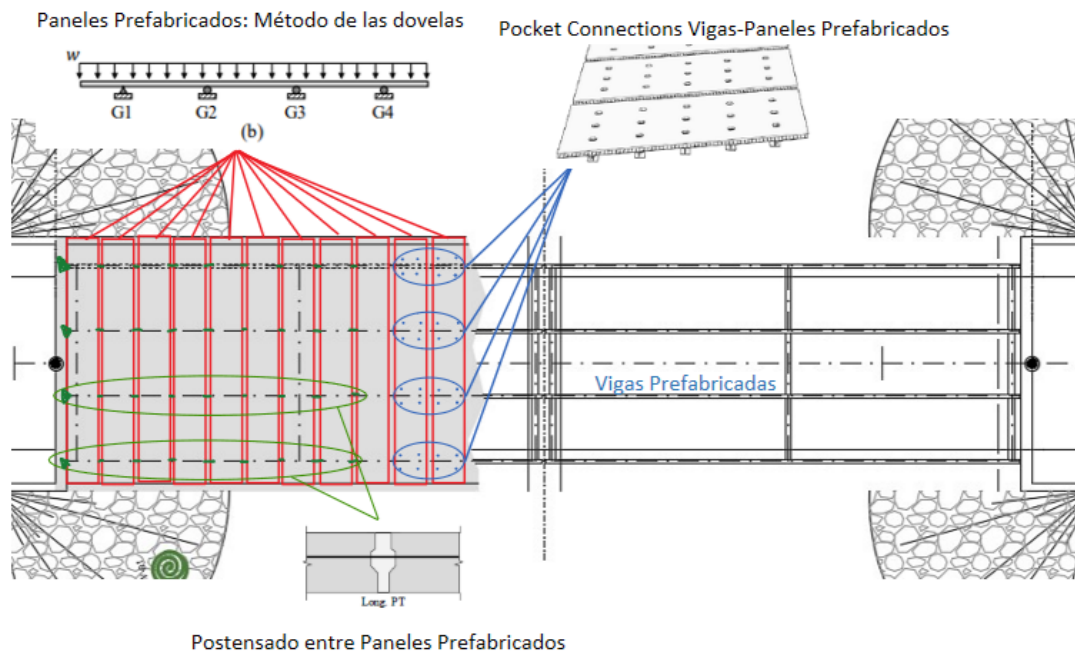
Elementos y conexiones a diseñar superestructura. Fuente: Planos de Proyecto modificados.
